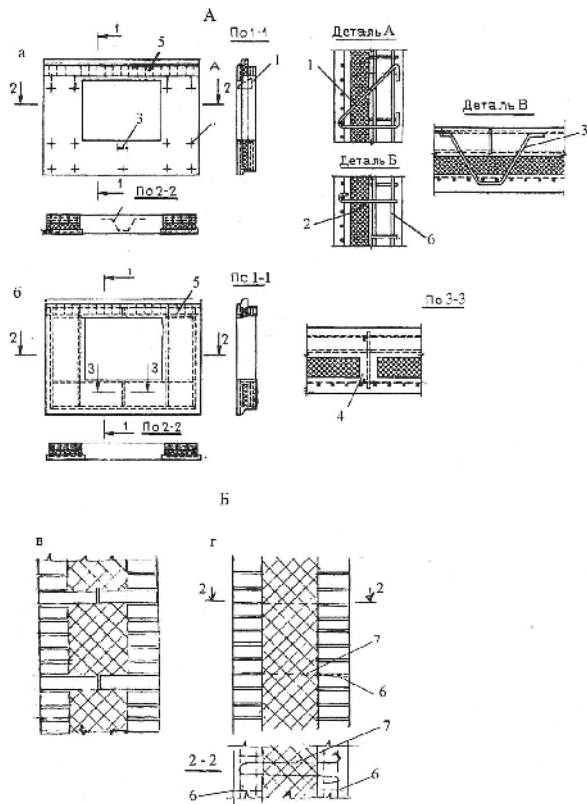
Связи между слоями трехслойных стен: А – в панельных стенах: а – гибкие связи; б – жесткие связи; Б – в кирпичных стенах: в – жесткие; г – гибкие; 1 – подвеска; 2 – распорка; 3 – подхос; 4 – жесткая связь; 5 – арматура перемычки; 6 – арматурный каркас; 7 – петлевой анкер
